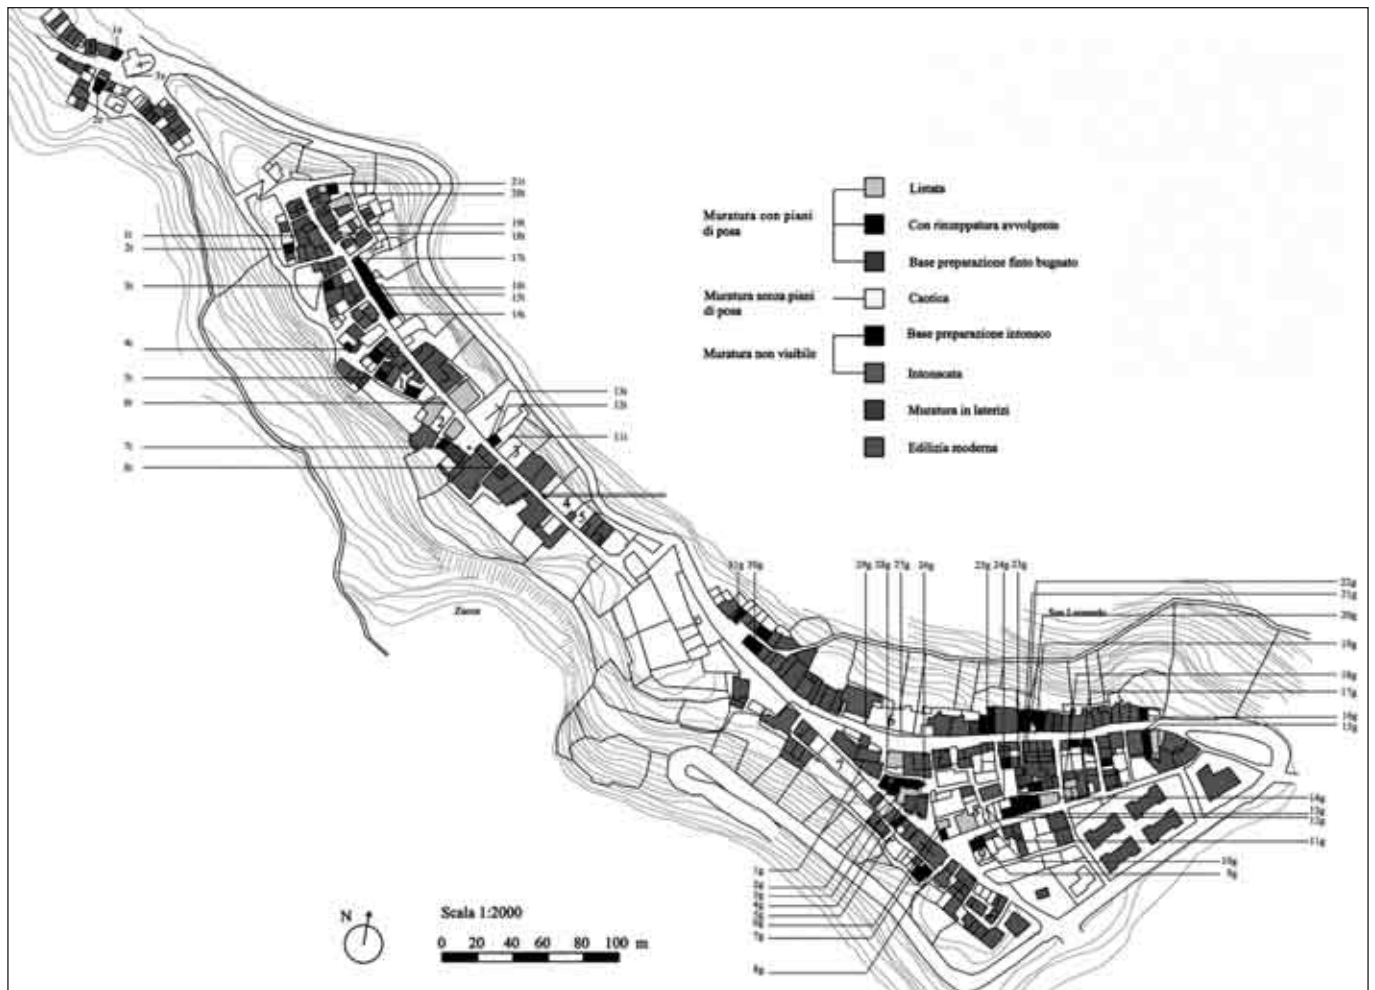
Bovalino. Planimetria del centro con la distribuzione delle tipologie edilizie.
